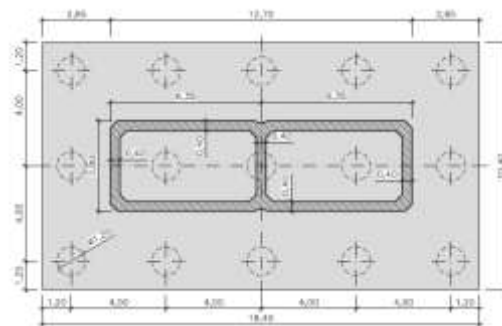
Planta pila cajón Tipo 3 para apoyo de tablero de calzada doble.
